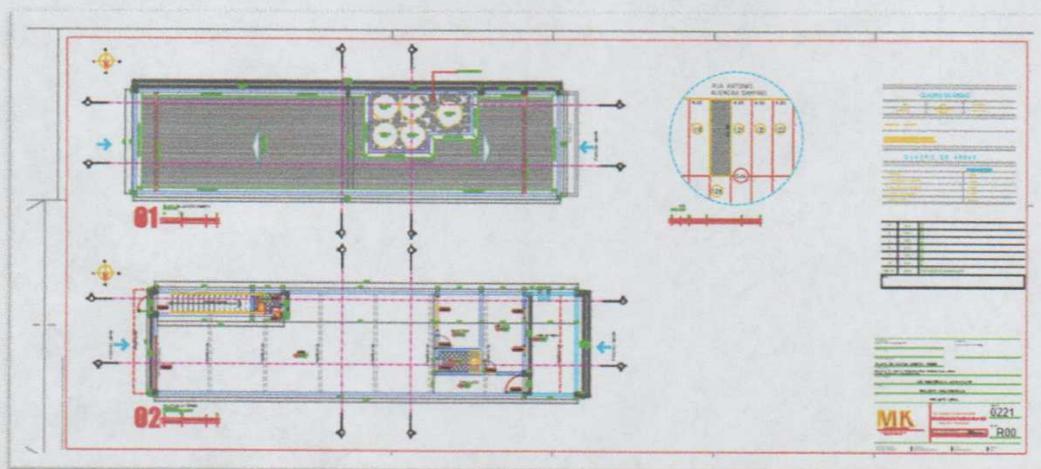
Planta de locação coberta, Planta de situação, Planta baixa térreo.
